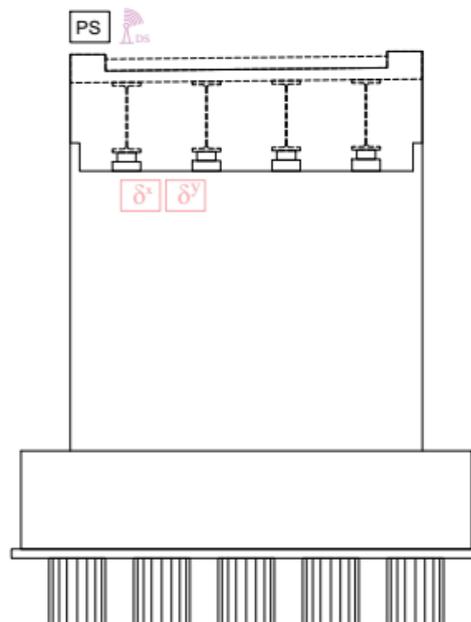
Ubicazione sensori su spalla (es. viadotto MdP)
